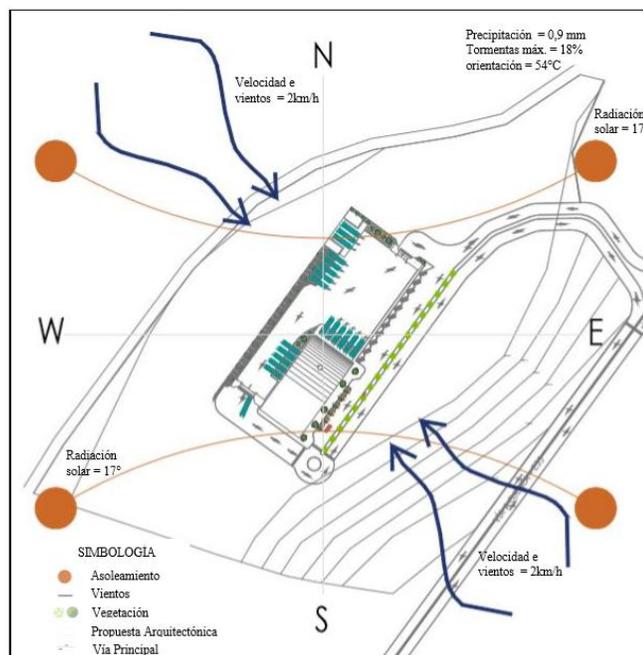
Implantación general de la Propuesta de la Terminal Terrestre
